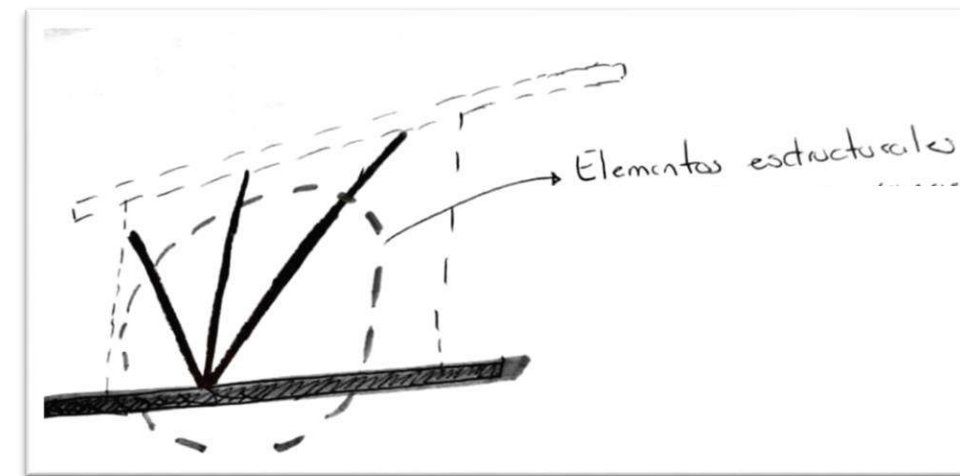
Descomposicion de Figuras para elementos en fachadas
